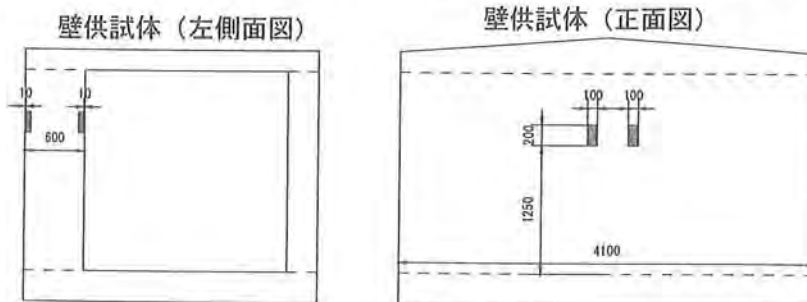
壁供試体の欠陥状況および測定範囲 (■：ポーラスコンクリート)
